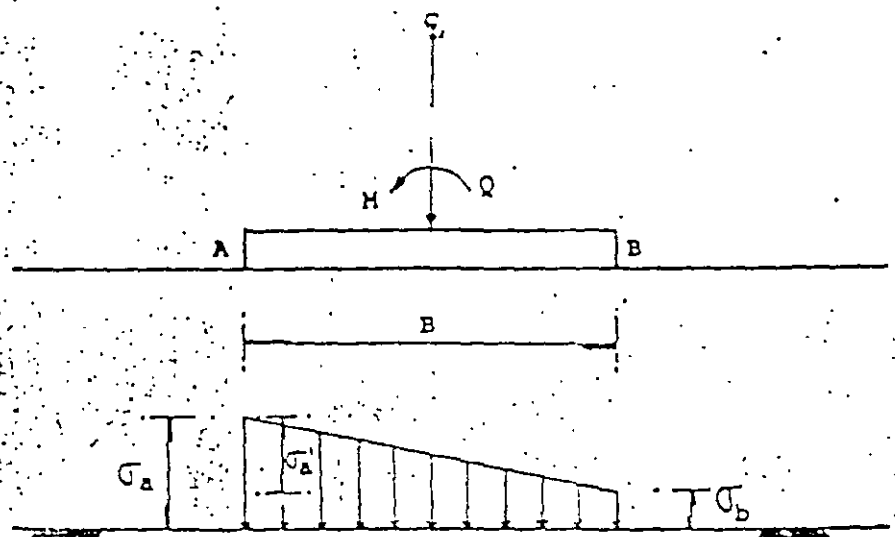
CARGA TRAPEZIAL SOBRE EL TERRENO
